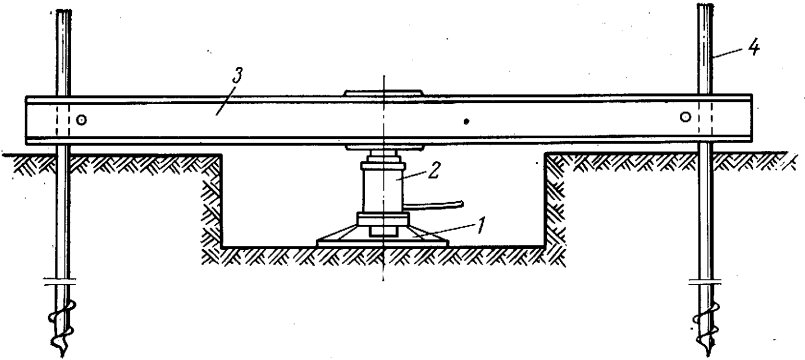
Схема установки для испытания грунтов в шурфе статической нагрузкой:
